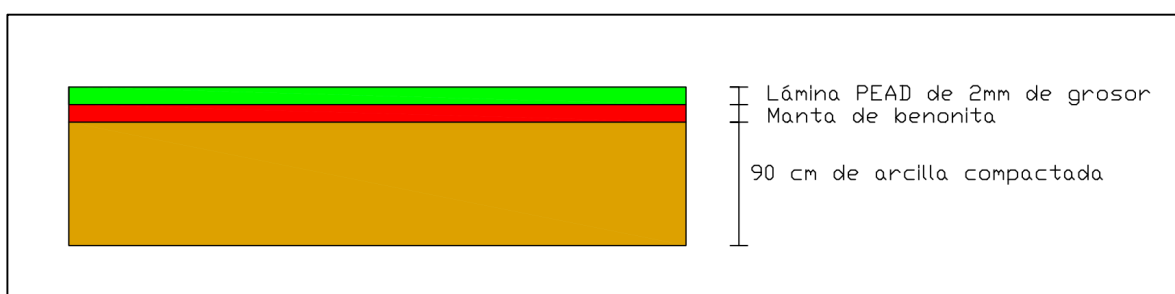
Sección de la capa impermeabilizante con barrera mineral natural. Fuente: Elaboración propia.
